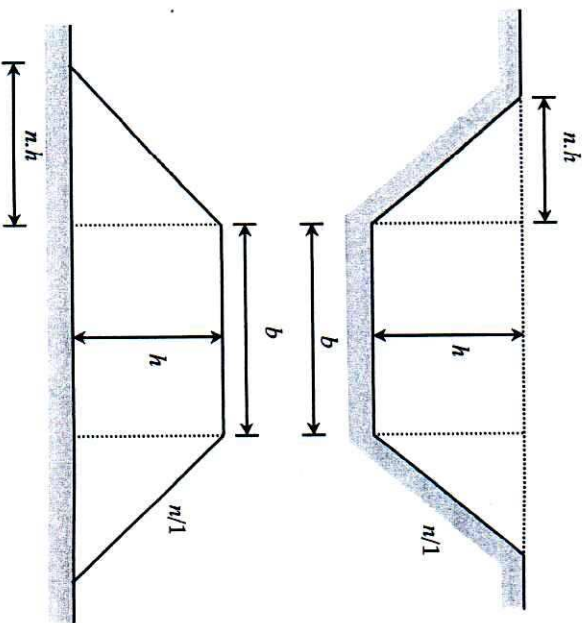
Área de uma seção transversal num terreno plano.
